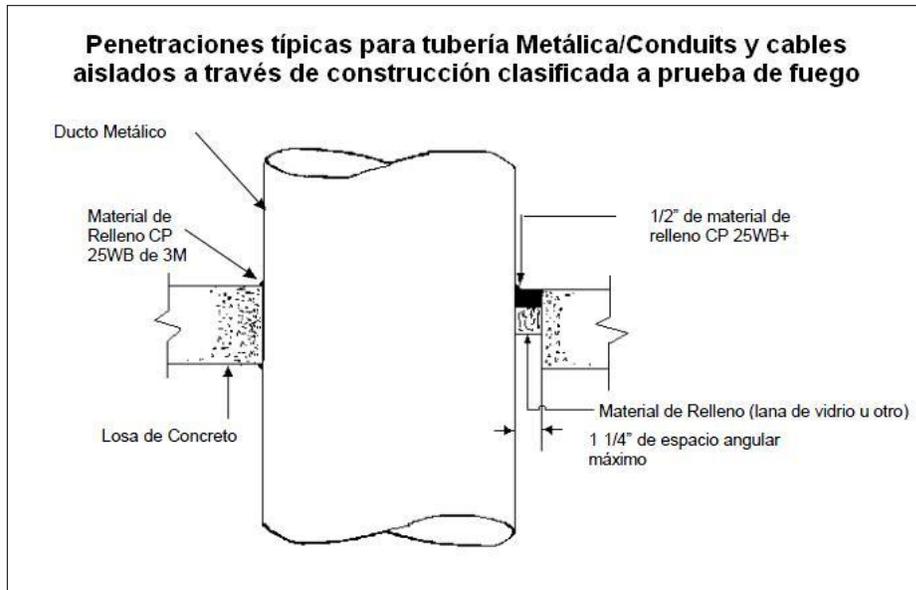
Detalle de instalación de una tubería metálica/Conduits y/o cables a través de una losa de concreto.
